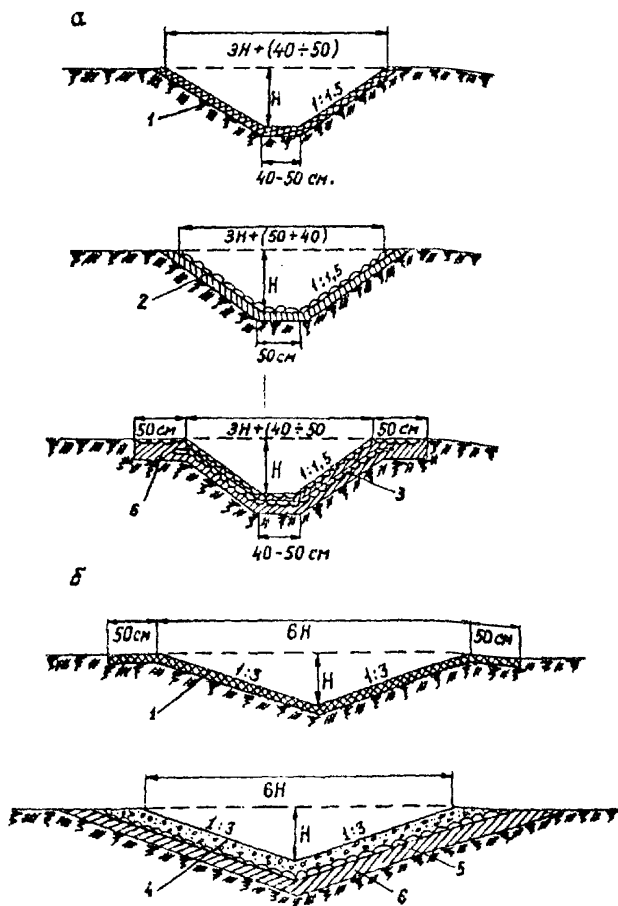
Конструкции элементов водоотводных сетей на вечномёрзлых грунтах:
